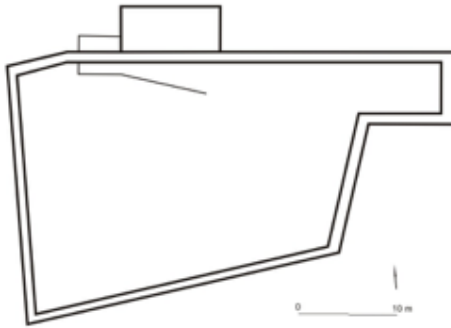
Croquis de planta de la fortificación de Hoyo del Tío Benito (Berrocal).
